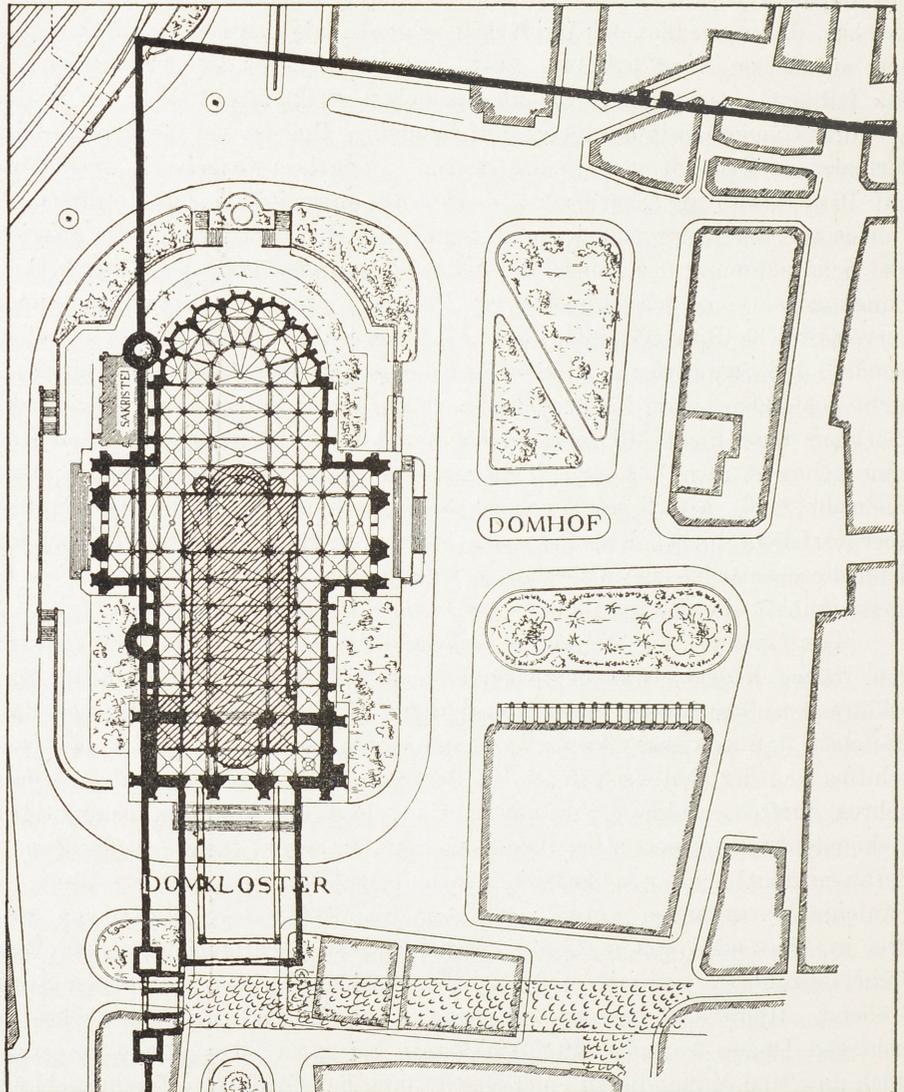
Grundriss des Kölner Domes¹⁾.
